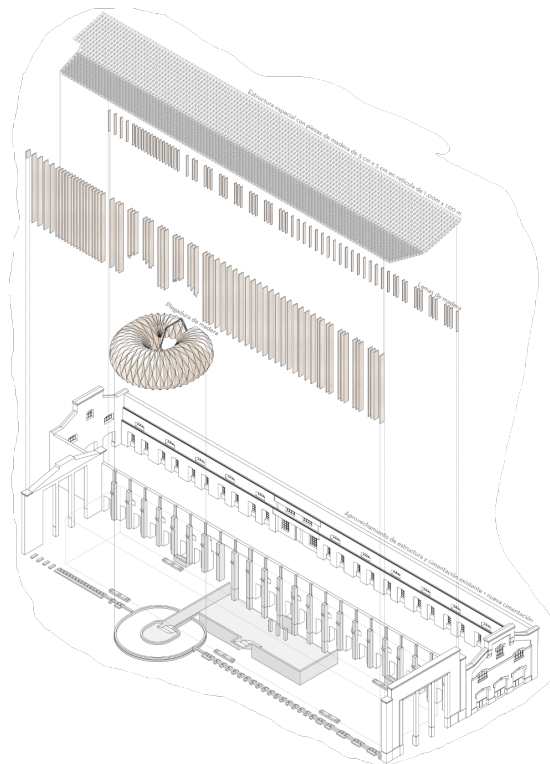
Axonometría sistema estructural cimentación, plegadura y nave.
